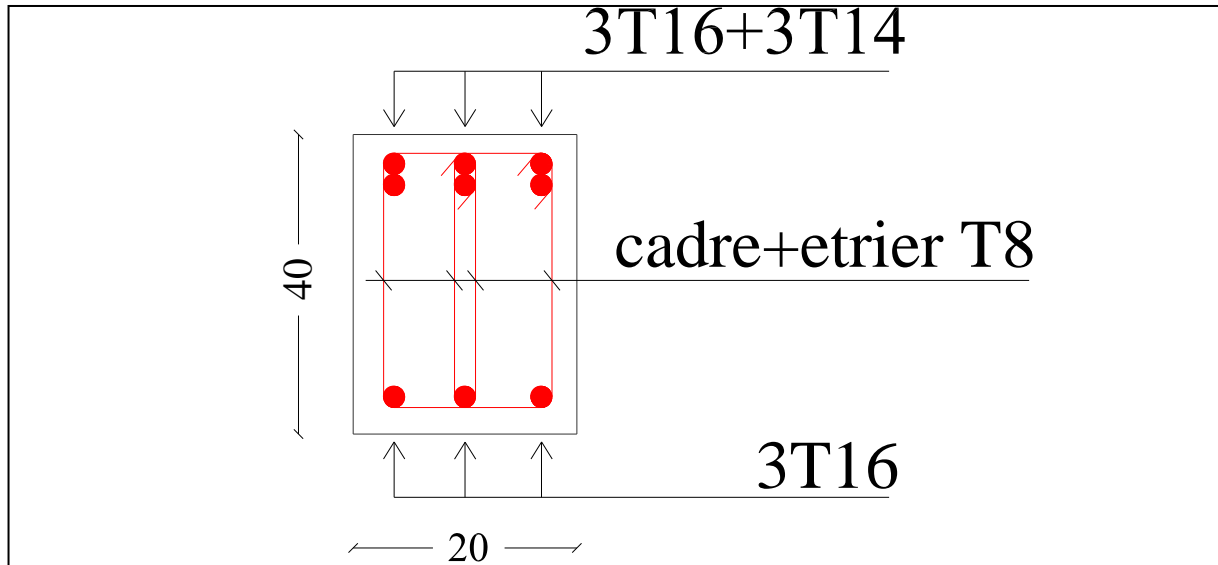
ferrailages des poutres principales (secondaires)
